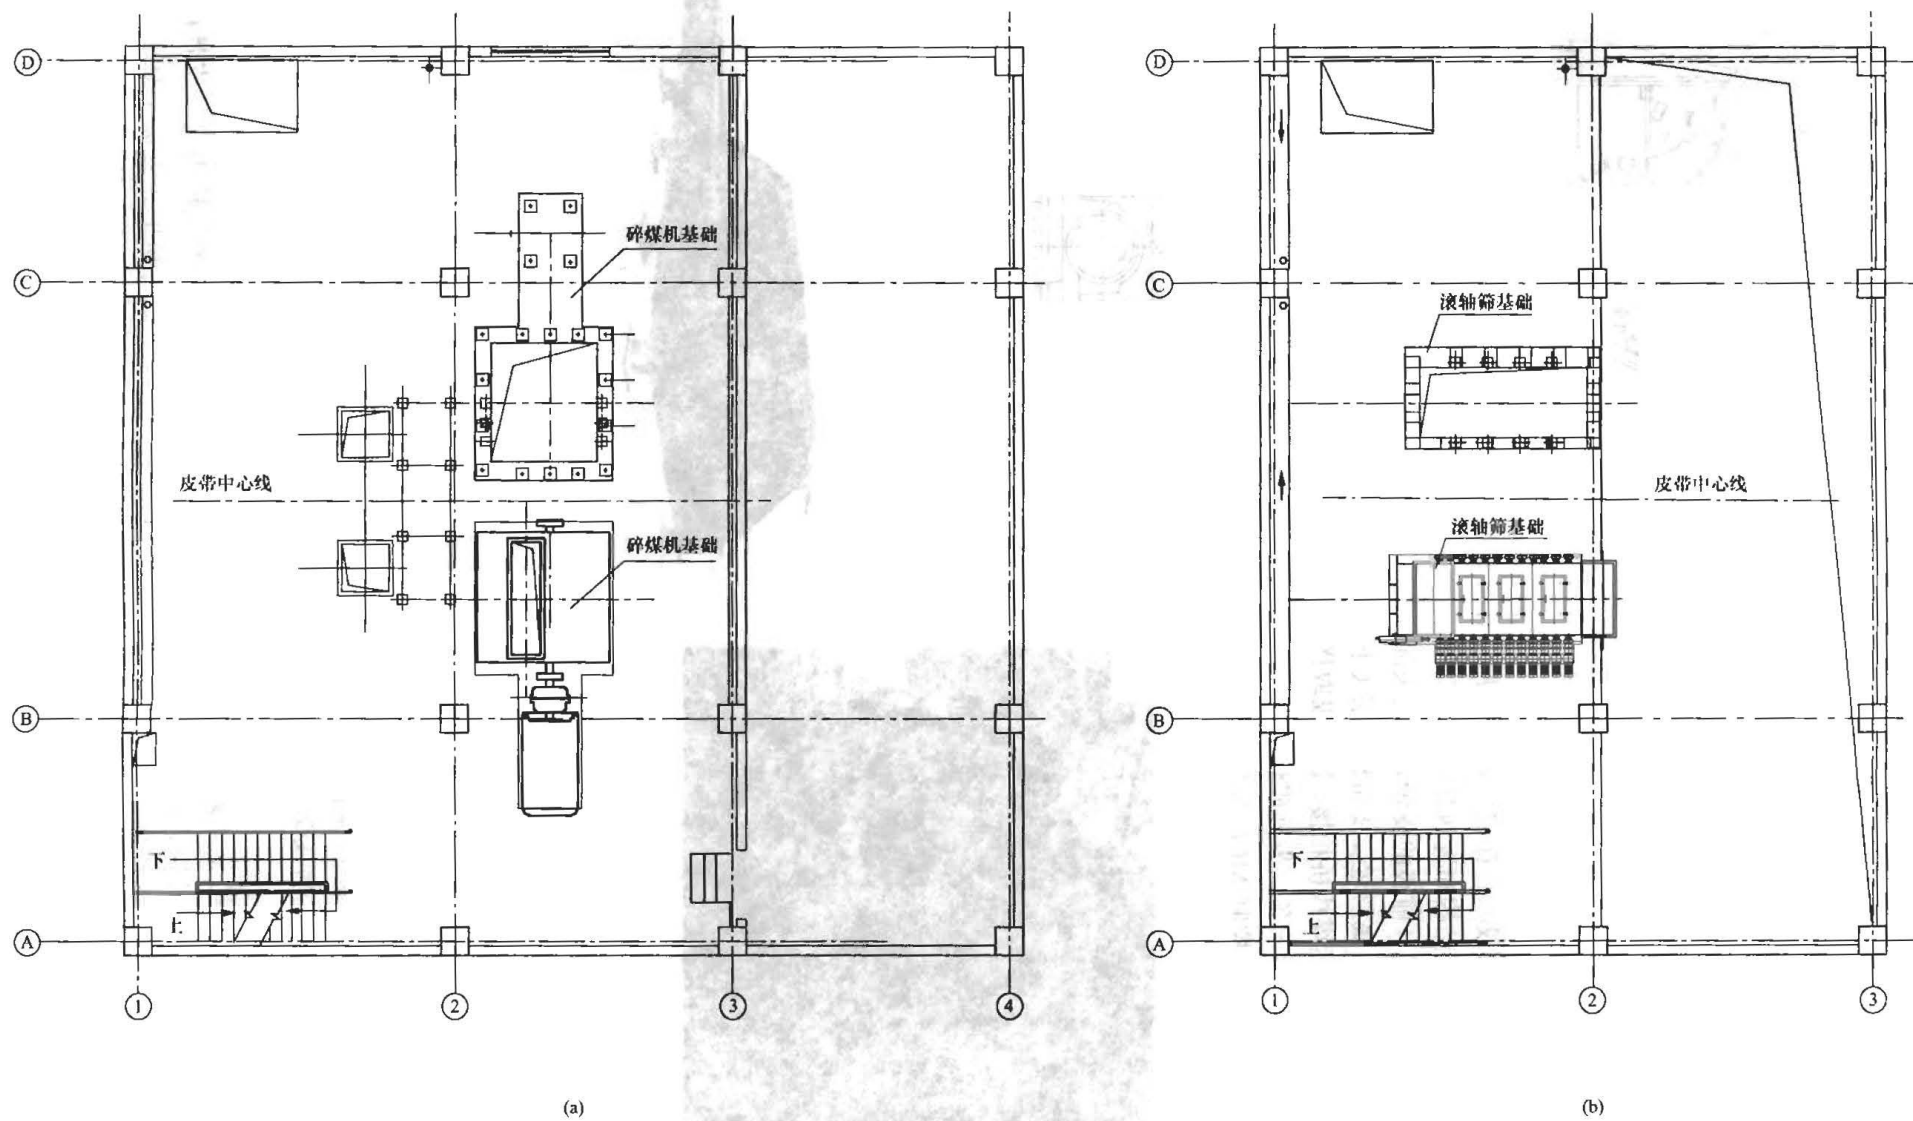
碎煤机垂直于皮带的平面布置图 (一)
